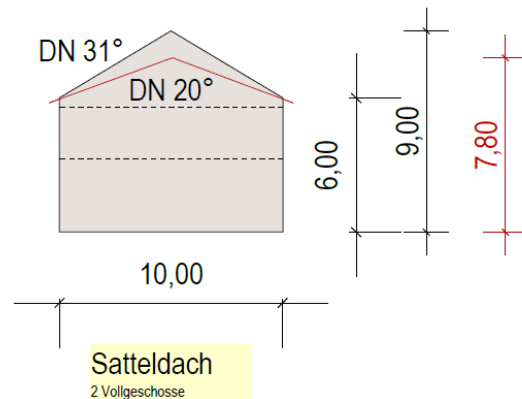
Mögliche Gebäudeausführung bei Haustyp II
